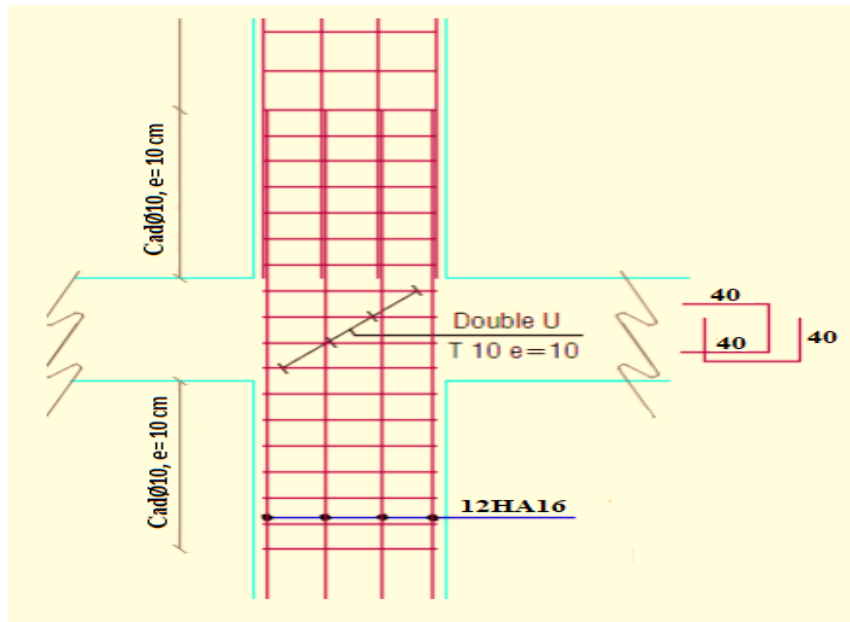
Ferrailage de recouvrement des poteaux 45×45 cm²
